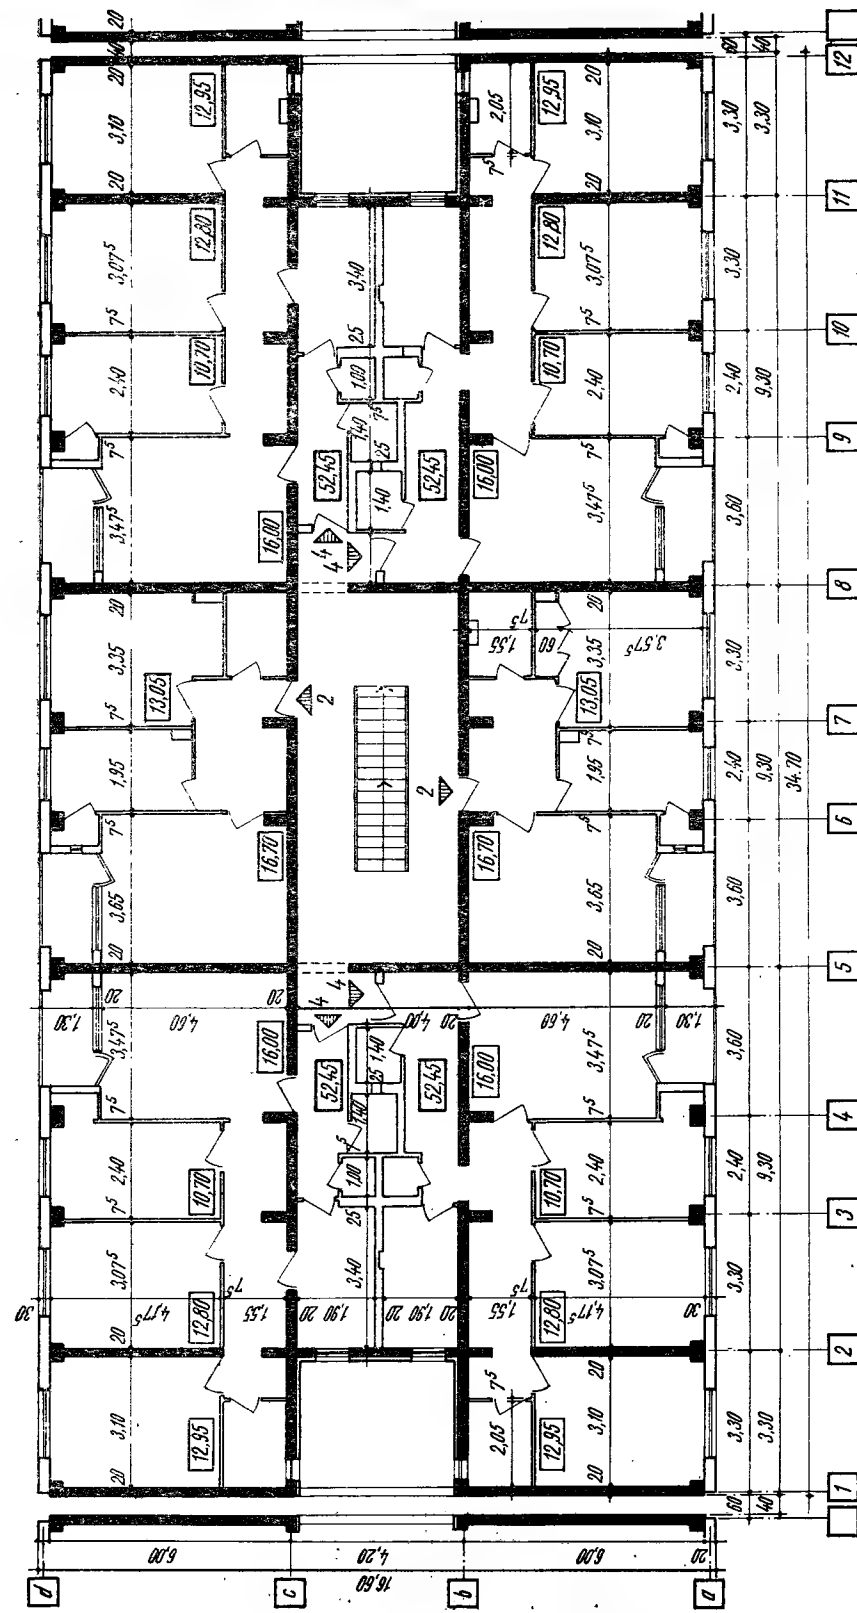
Plan etaj curent pentru o construcție de locuințe, P + 4E, cu patru apartamente la scară, amplasată în zone cu grad VIII de seismicitate și având structură celulară cu diafragme din beton armat, turnate monolit.
